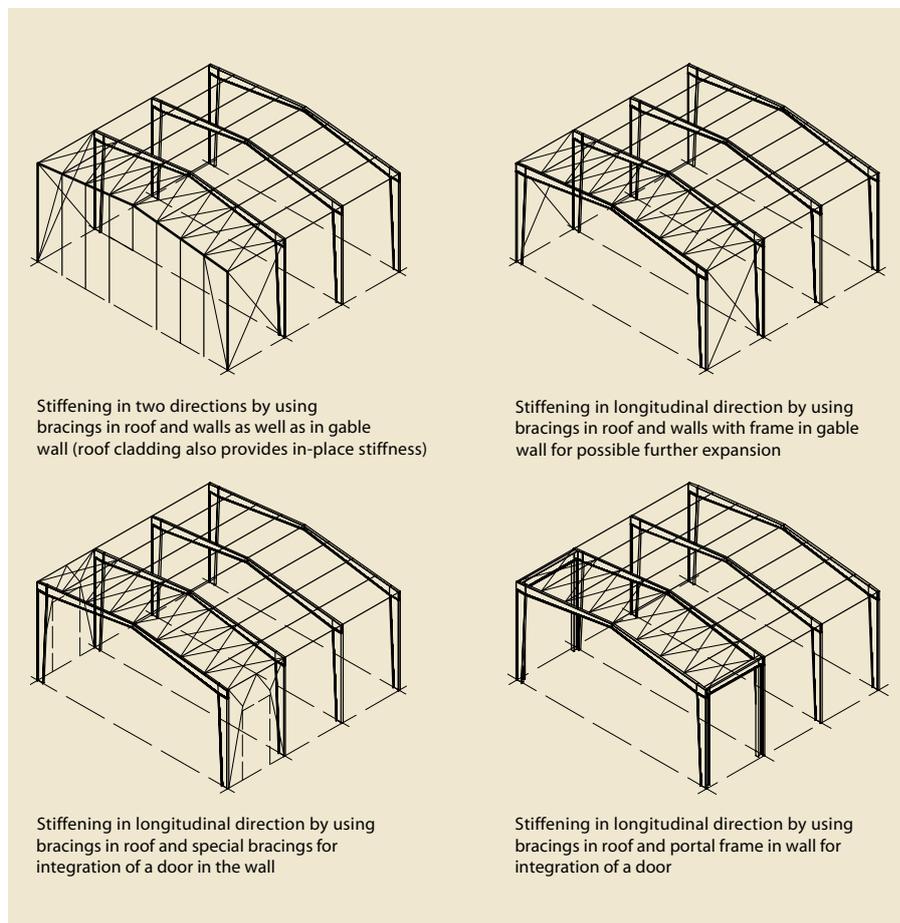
Ejemplo de arriostramientos fuera de plano del pórtico
